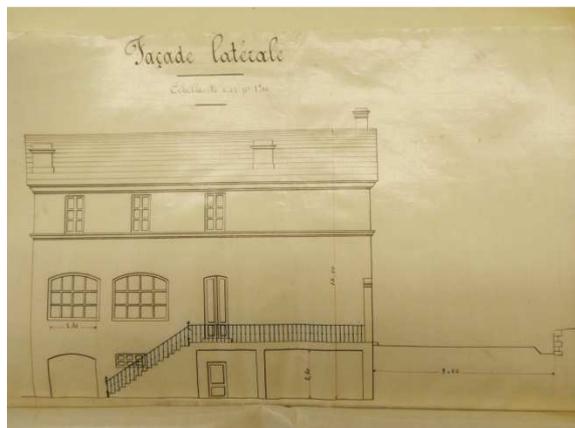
Projet de construction d'une maison d'école avec mairie, façade latérale, Angeli (conducteur des Ponts et Chaussées).
